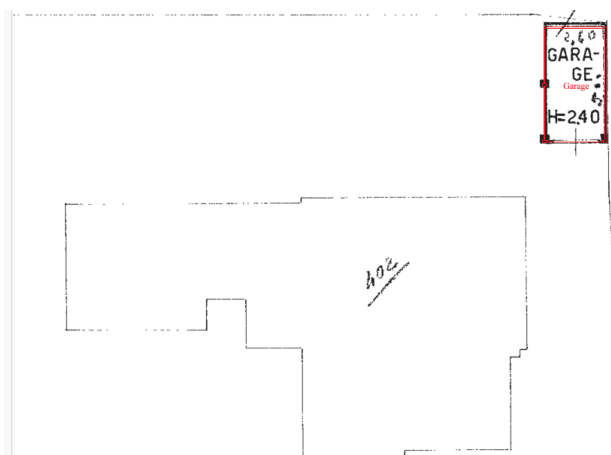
Sovrapposizione planimetria catastale/stato di fatto garage piano (fuori scala) – (Allegato L.03.03)
